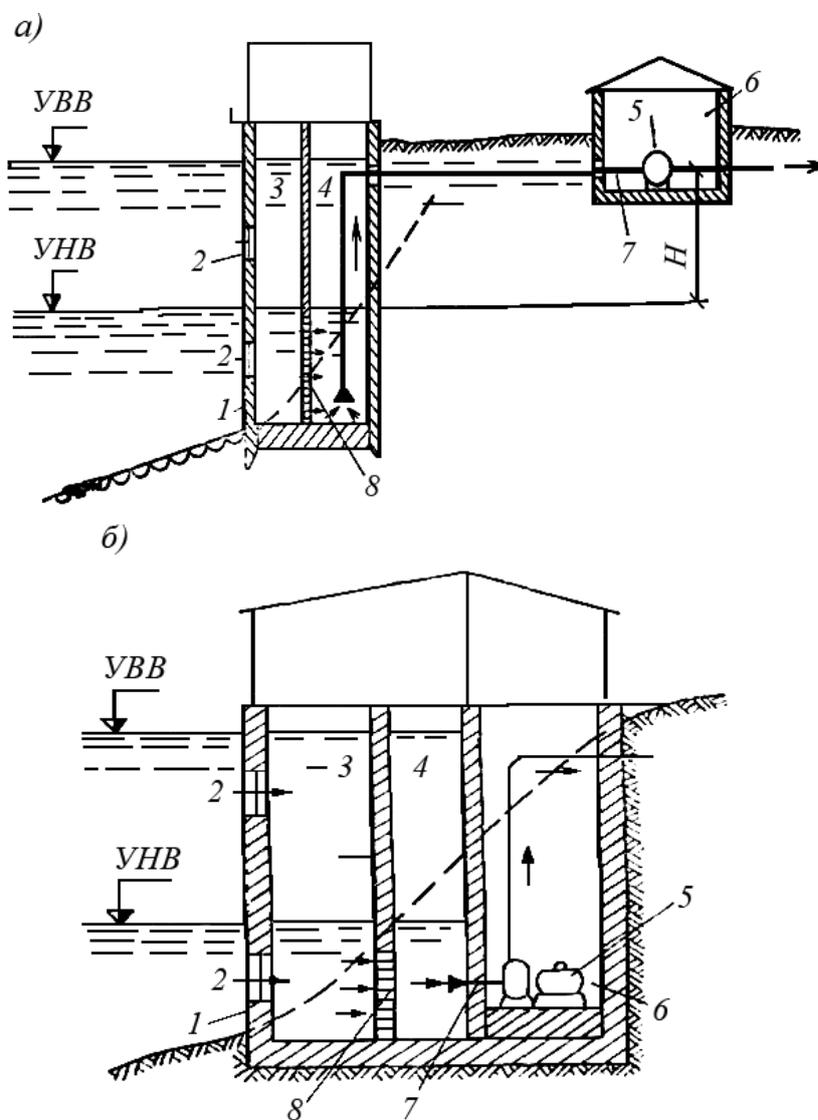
Водоприемники берегового типа: а – отдельный; б – совмещенный; 1 – водоприемный колодец; 2 – входные окна; 3 – приемная камера; 4 – всасывающая камера; 5 – насосы; 6 – машинный зал; 7 – всасывающие трубопроводы; 8 – сетки
